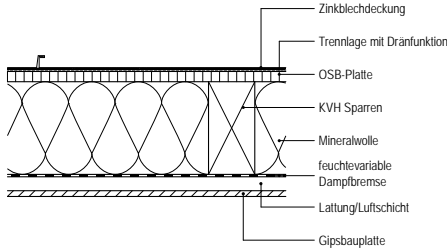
Nicht belüftetes Dach mit nicht belüfteter Dachdeckung, Zwischensparrendämmung (Konstruktion 3)
